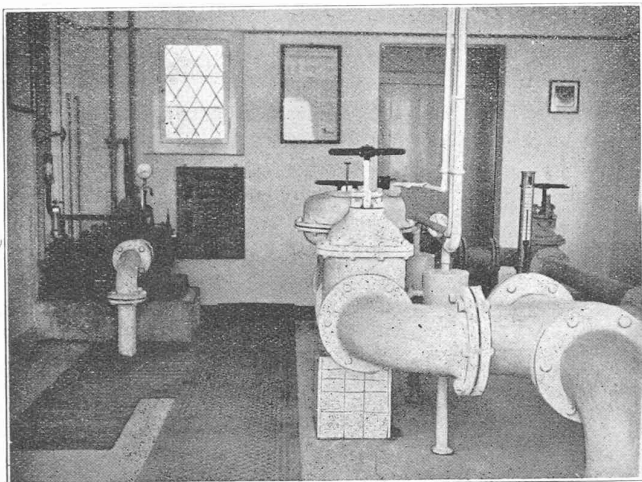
Vue de l'appareil de réglage et du compresseur.
